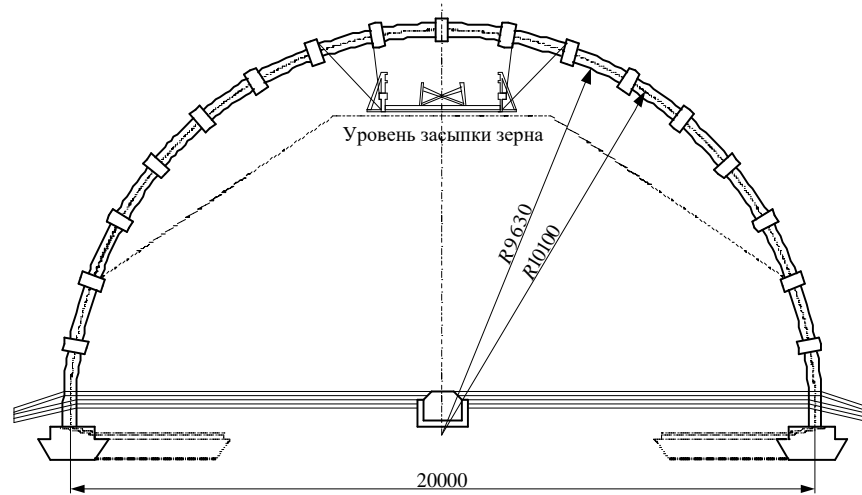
Механизированный зерновой склад облепченной сводчатой конструкции
